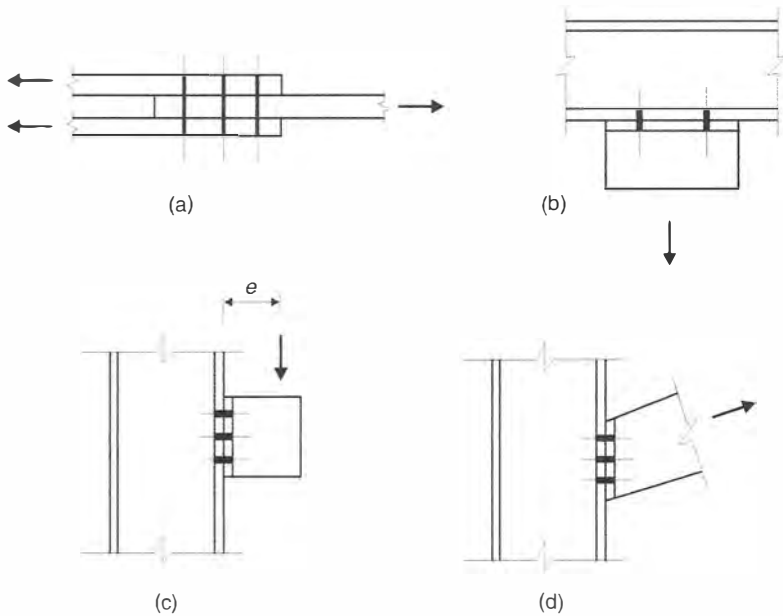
(a) Ligação por corte; (b) ligação por tração; (c) e (d) ligações a corte e tração dos conectores.
